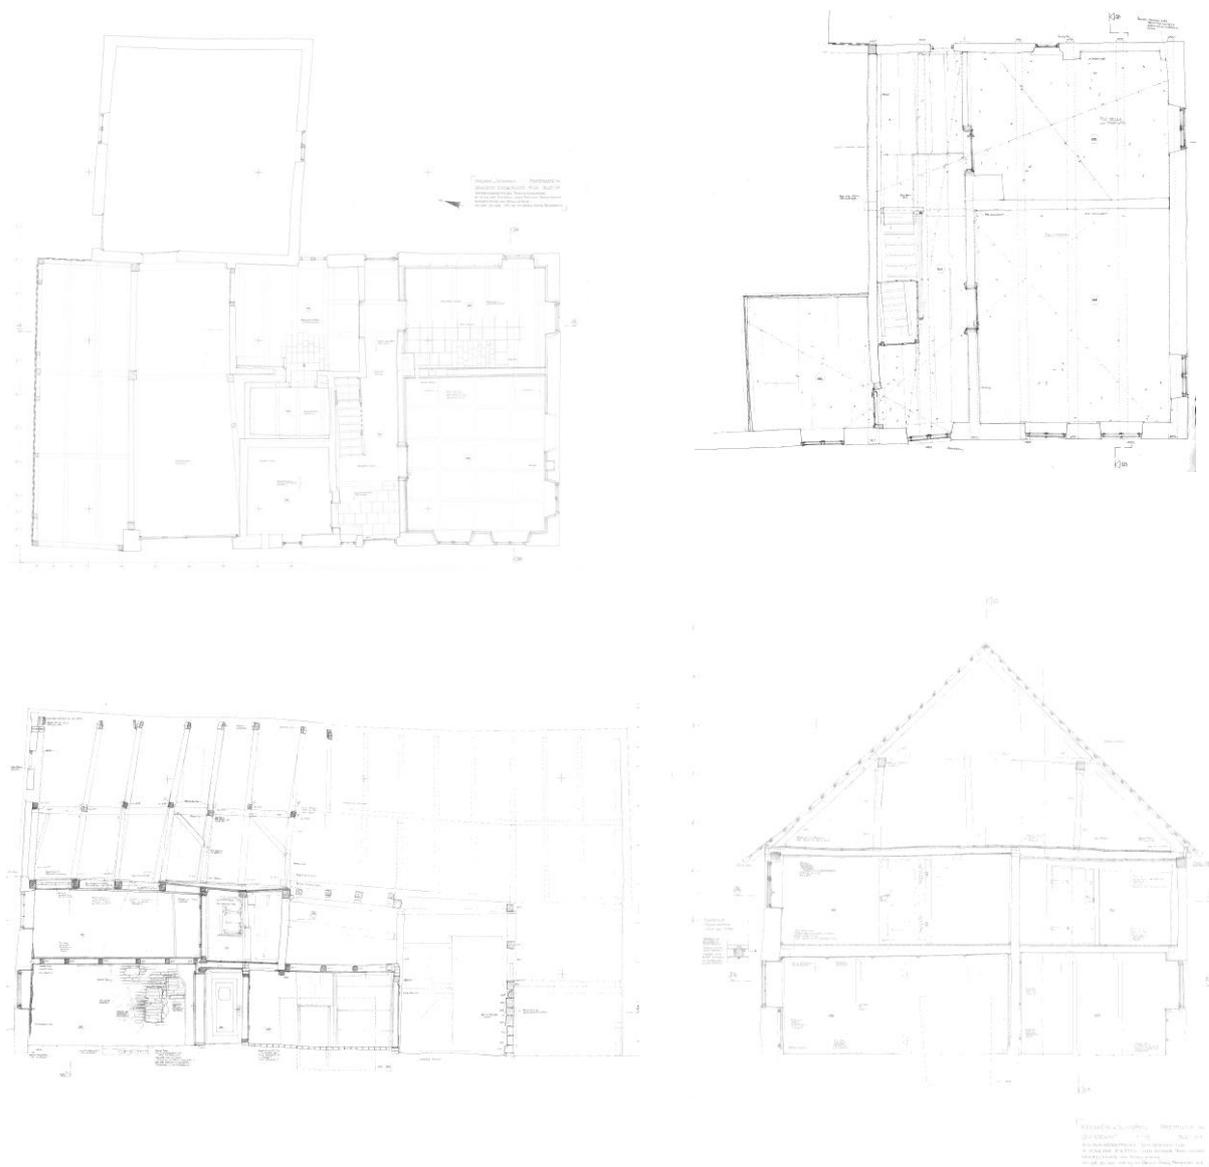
Zeichnerische Bauaufnahme, oben links Grundriss EG, oben rechts Grundriss OG, unten links Längsschnitt, unten rechts Querschnitt
